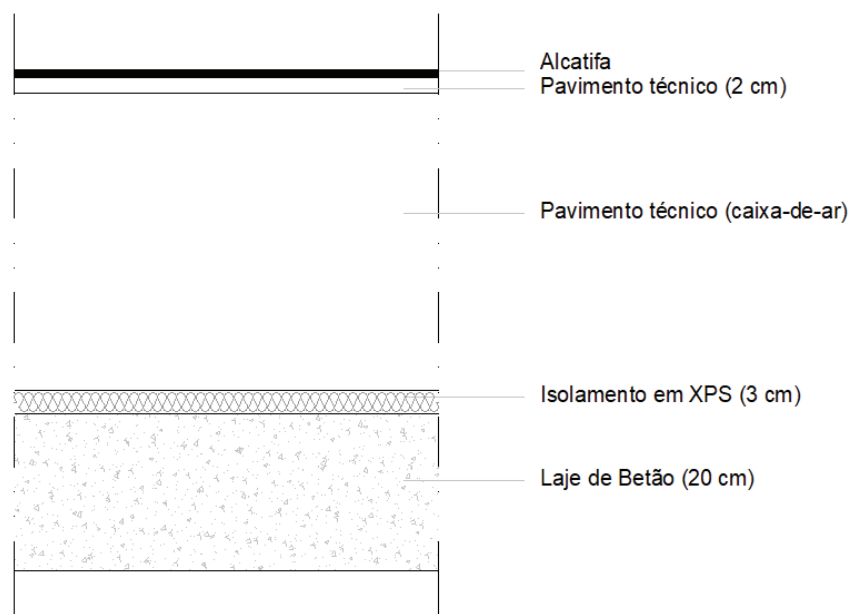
Pormenor construtivo do pavimento interior tipo III (cota 9.37-event space e temporary exhibition)
